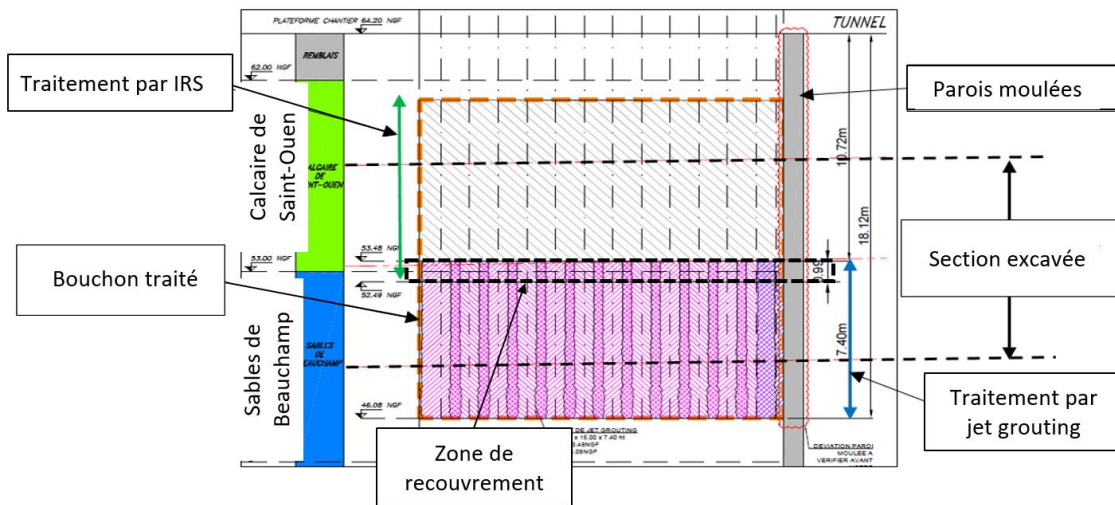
Coupe longitudinale d'un traitement mixte type - Eiffage
